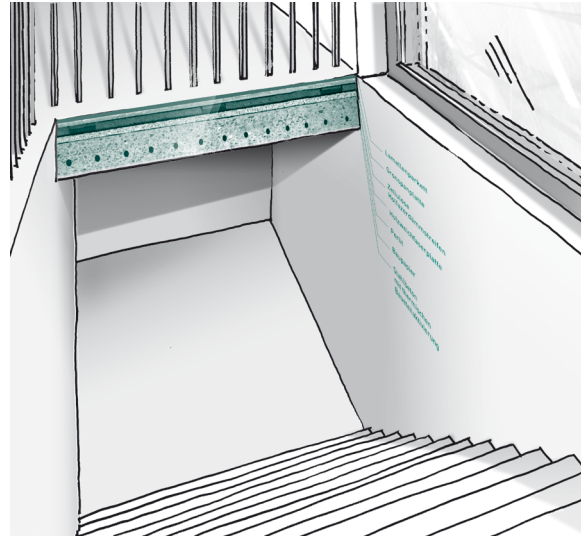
Geschnittene Deckenkante im Treppenloch demonstriert den Deckenaufbau
